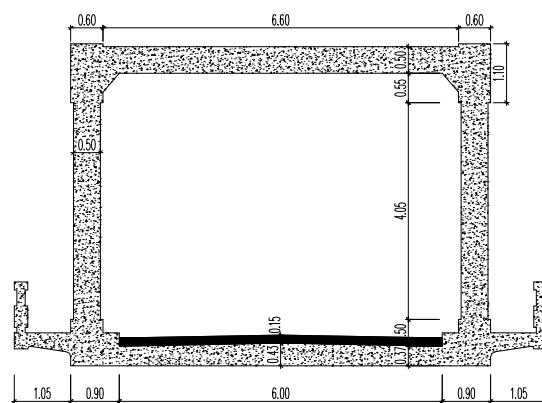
Secção transversal na zona das escoras superiores (dimensões em metros).
